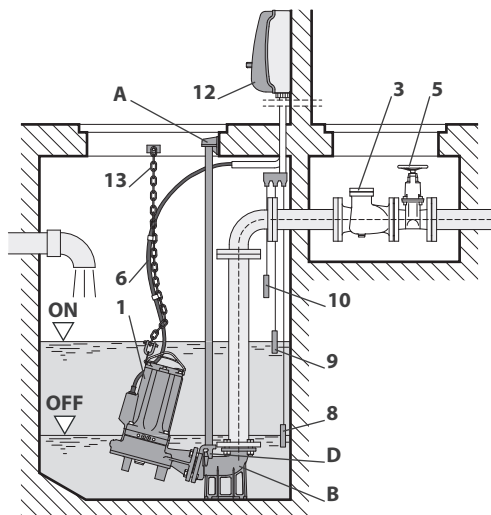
Installation triphasée sur pied d'accouplement automatique type Y.
